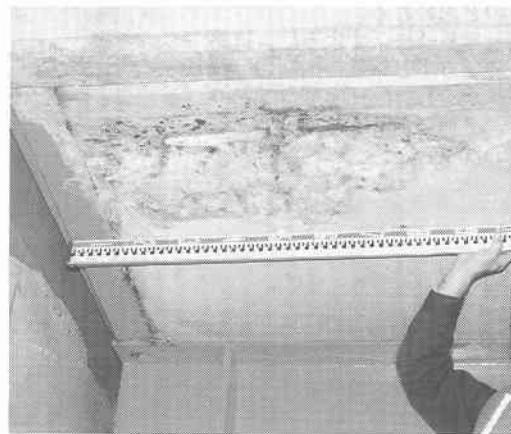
桁端部がアバットに衝突し端部のコンクリートが破損剥落しスター・ラップ等の鉄筋が露出
